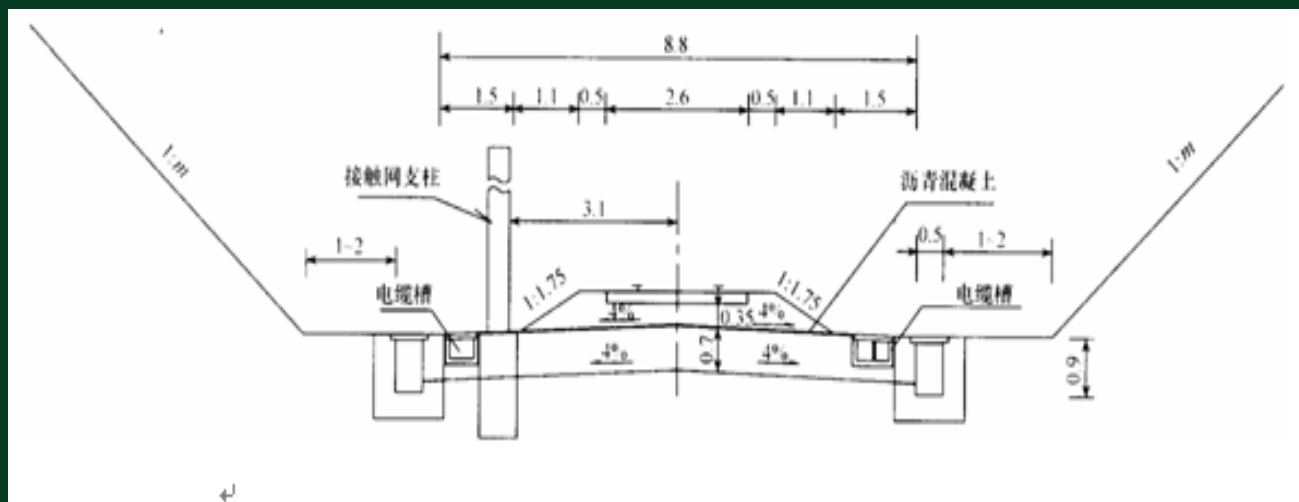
单线路堑（土质、软质岩石及强风化硬质岩石）标准横断面示意图（单位：m）
